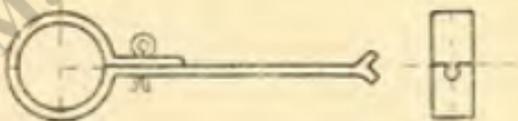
Хомут для укрепления труб на тонких стенах. Накладка под прямым углом к стене.
